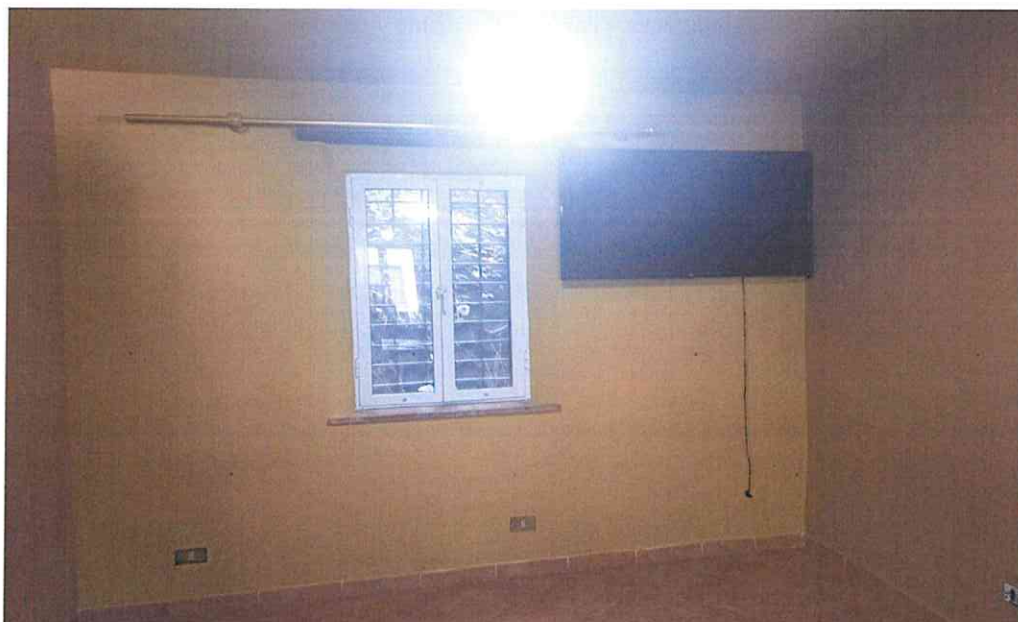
Foto interna – vano sala/soggiorno del piano primo lato sud verso monte
